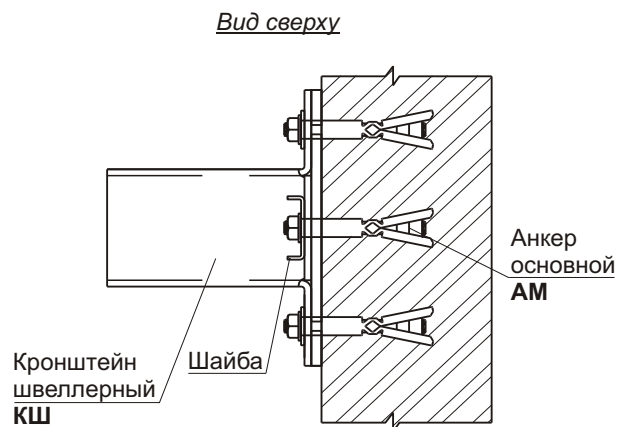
Крепление кронштейна КШ к стене тремя основными анкерами
